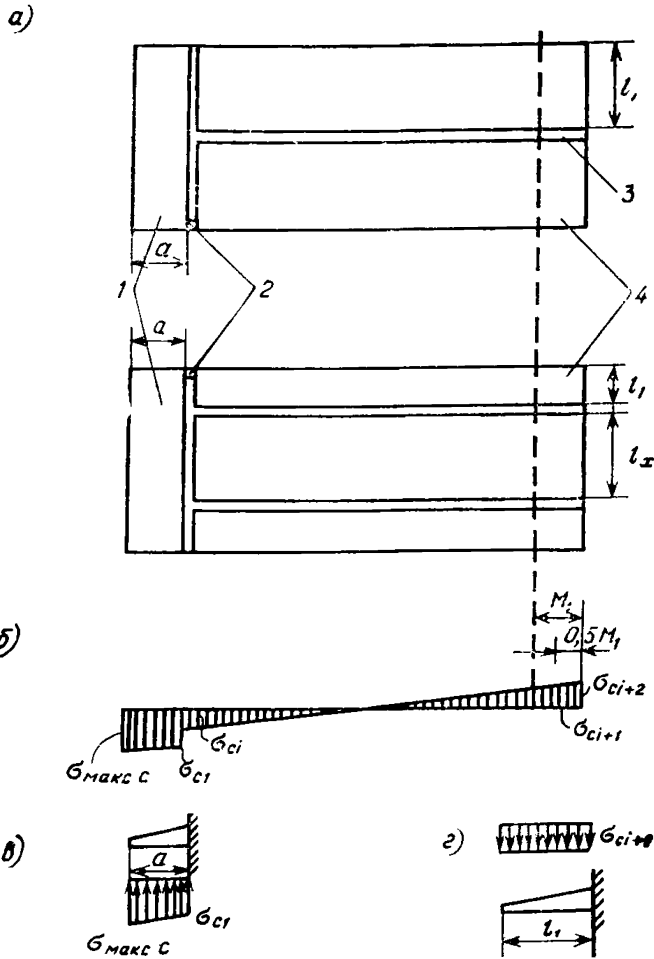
Схема расчета фундаментной плиты сборной уголковой контрфорсной стенки:
